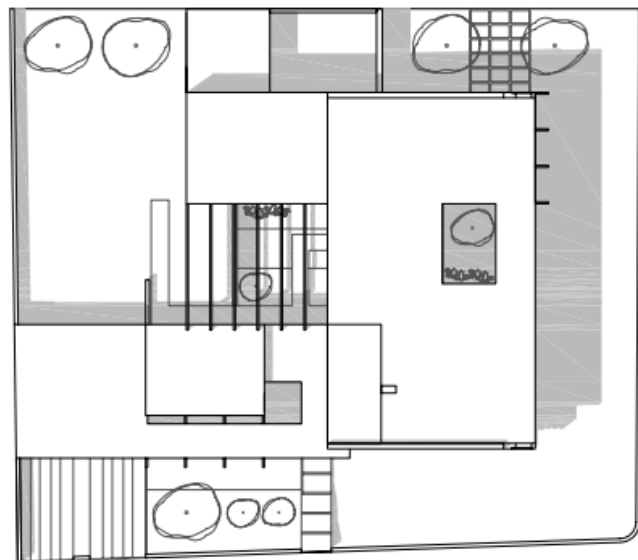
Plano de emplazamiento - Casa Becdach.
